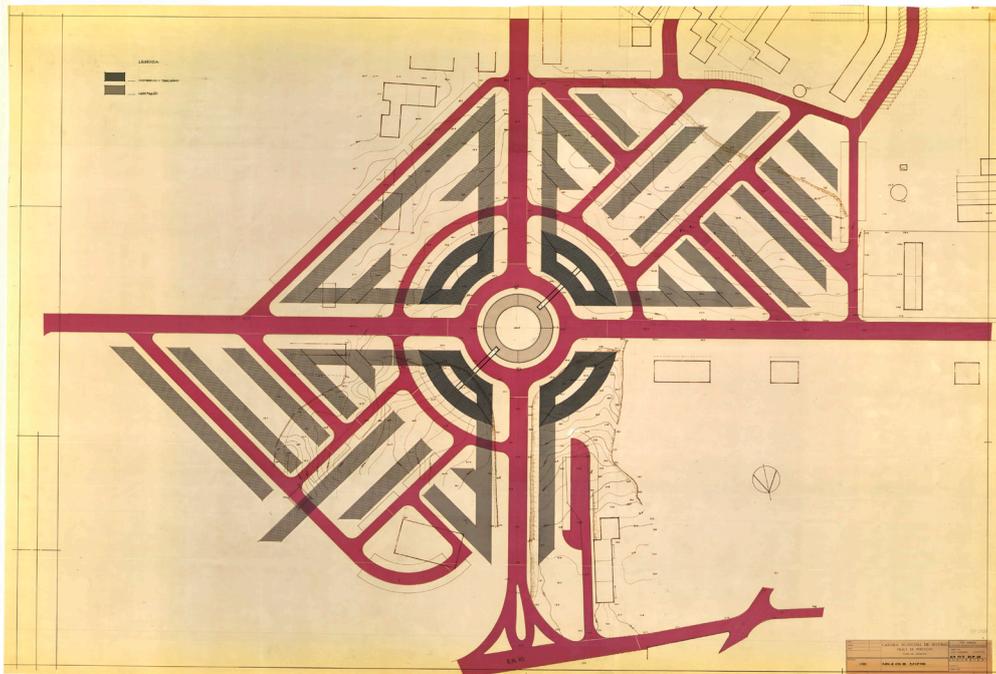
Plano de pormenor: planta ao nível do 3º, 4º e 5º pisos
